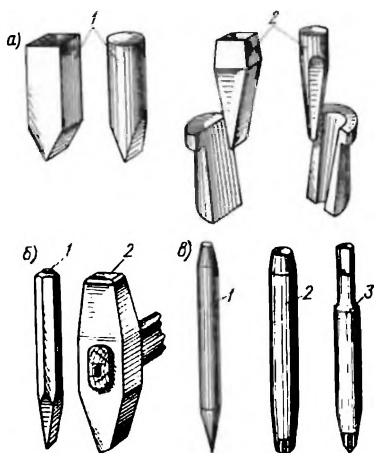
Ручной ударный инструмент для приближенной обработки камня
